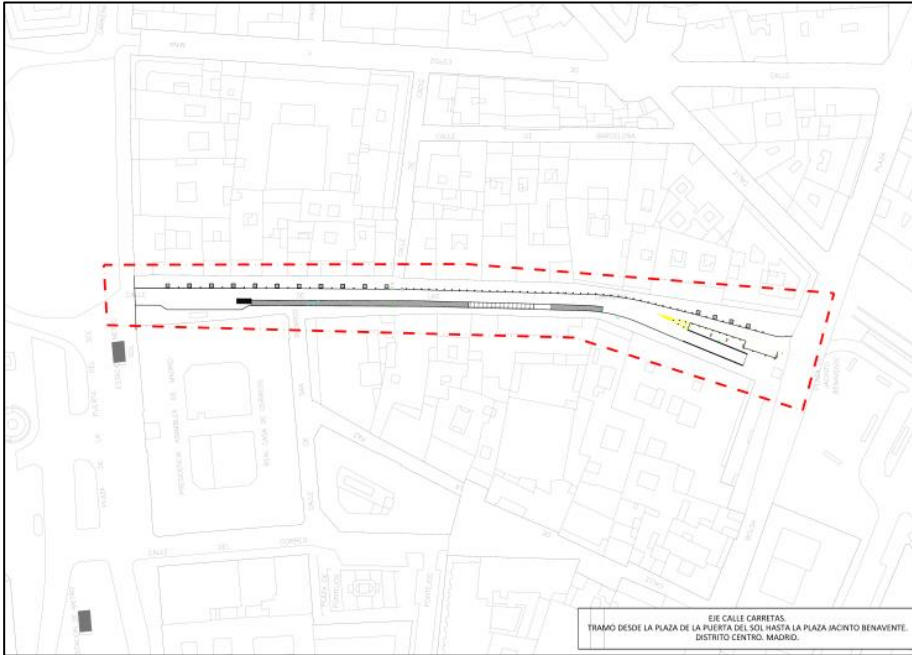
Ámbito de la obra de la Calle Carretas
